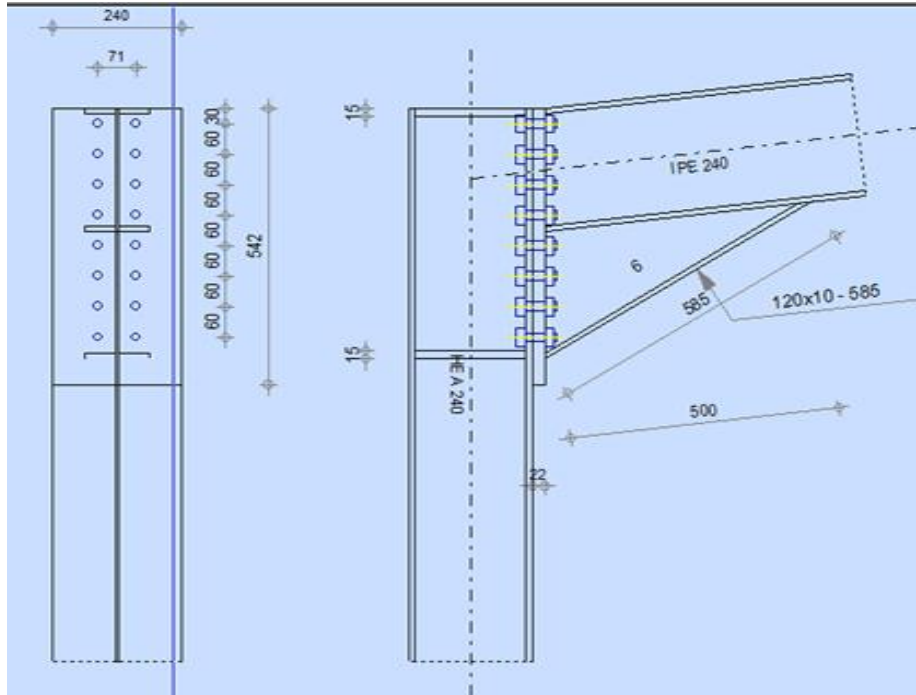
Schéma d'Assemblage poteau _ traverse.
